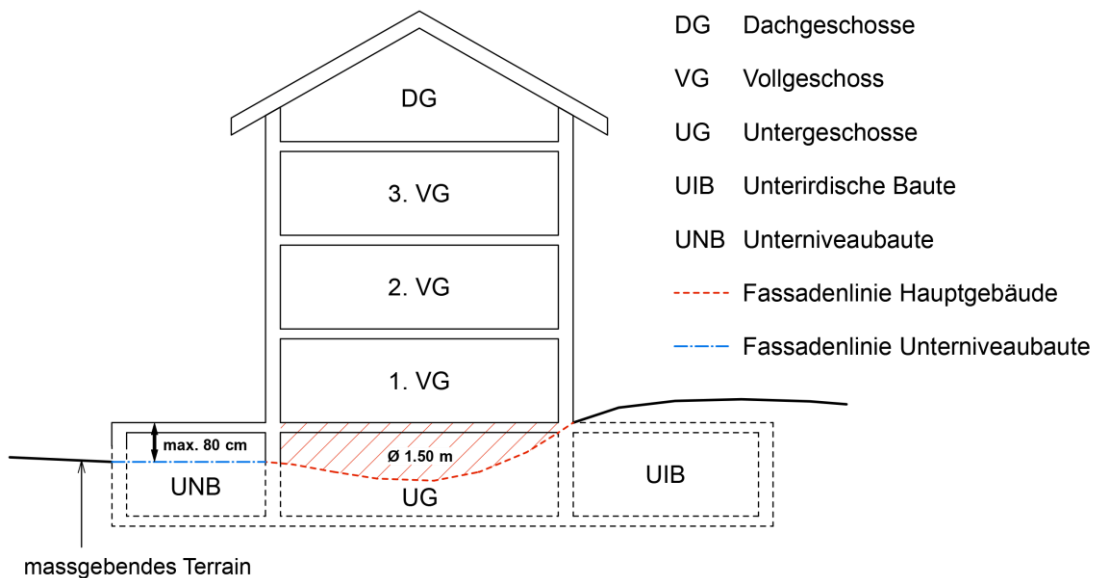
Darstellung der Unterniveaubauten, Untergeschosse und der unterirdischen Bauten.
